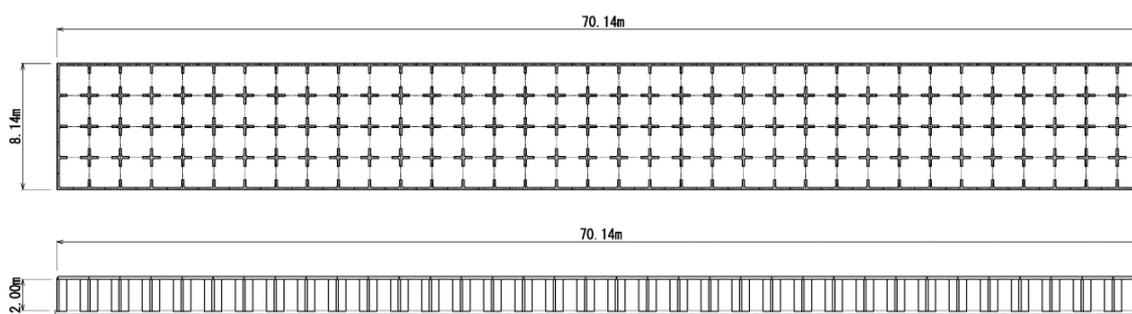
アクアポンドS 構造図（上：平面図、下：断面図）
